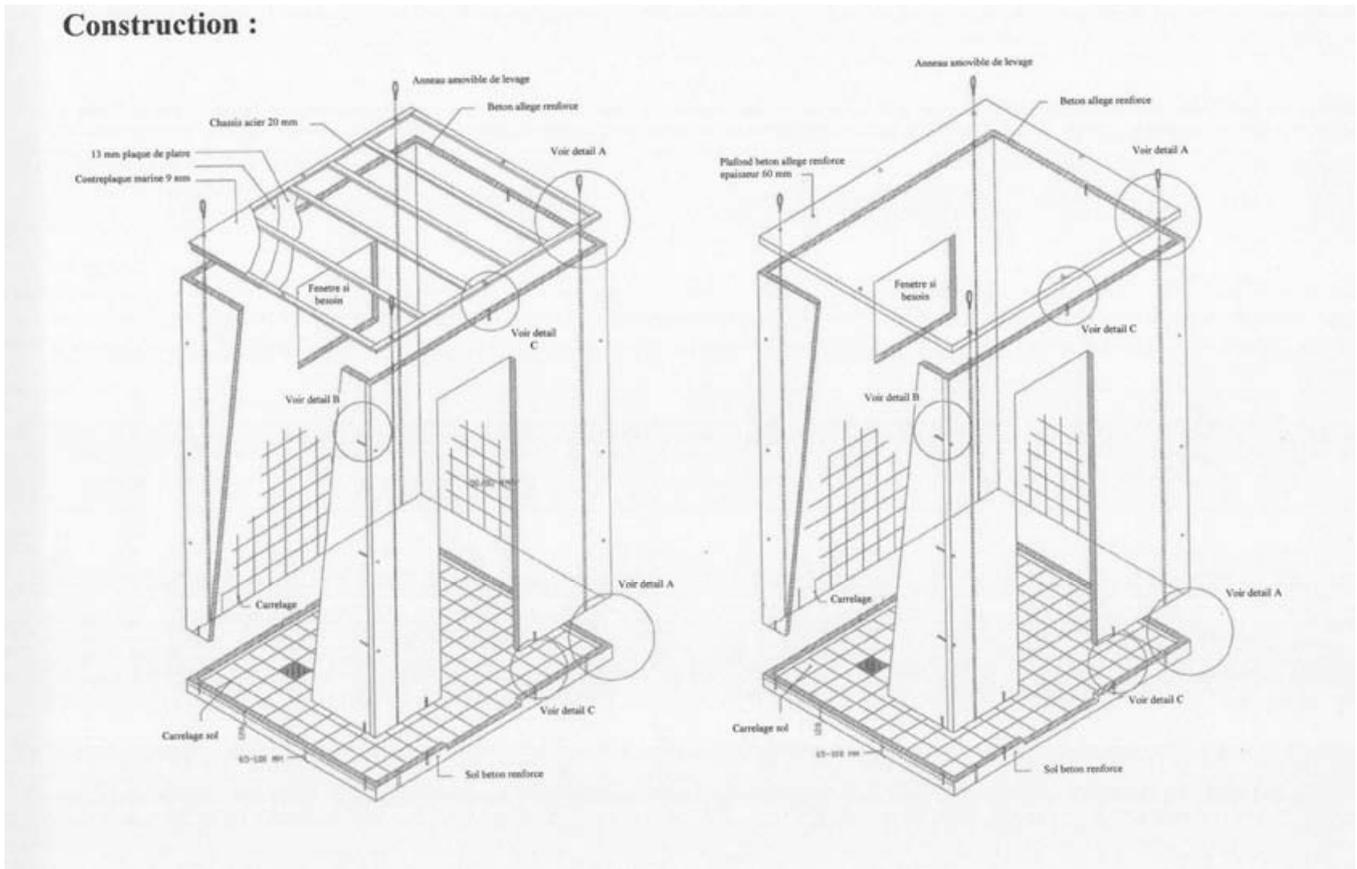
Schéma de principe d'assemblage d'un bloc sanitaire
